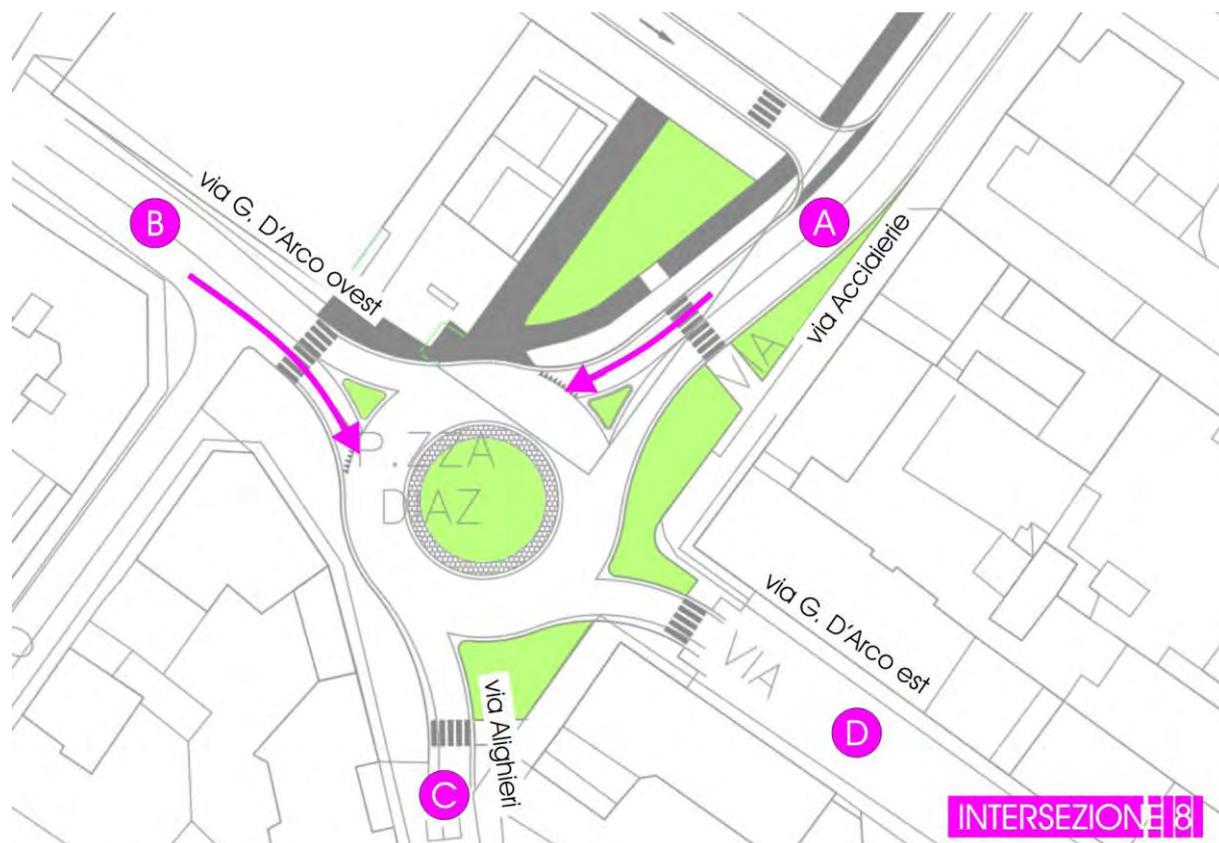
Scenario di Intervento 0 – Planimetria intersezione 8
